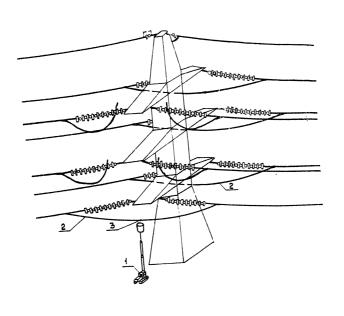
Монтаж петель шлейфа на анкерно-угловой опоре.
